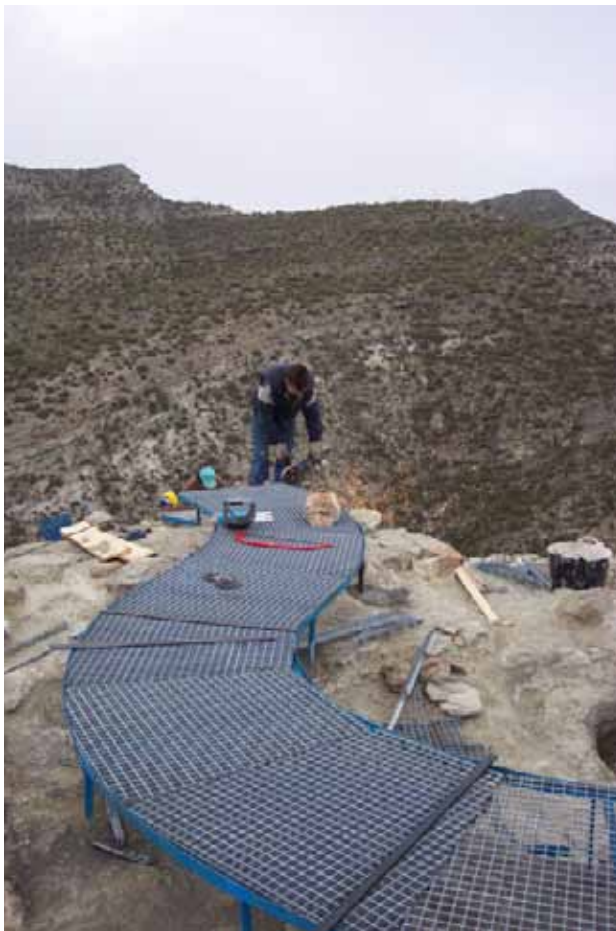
Construcción del mirador principal sobre la cima del asentamiento.
